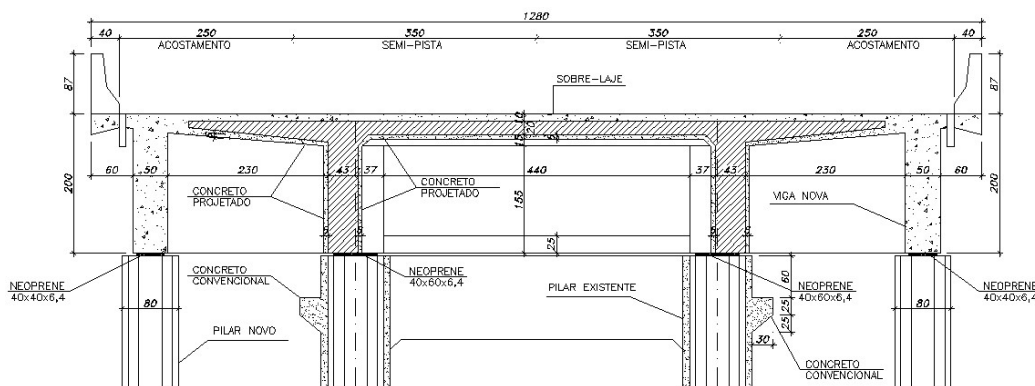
Seção transversal do alargamento de uma ponte com a adição de novas vigas e pilares de concreto armado.
